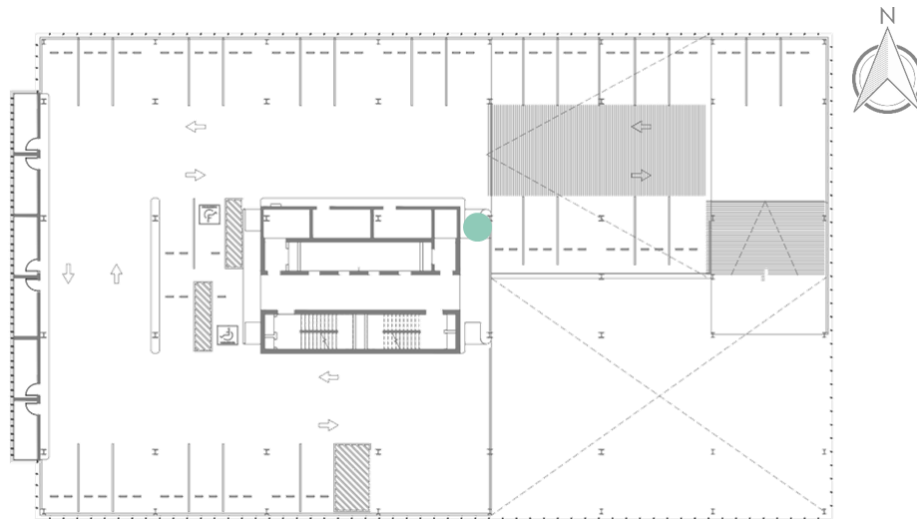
Planta arquitectónica nivel 08 | ubicación de equipos HOBO.
